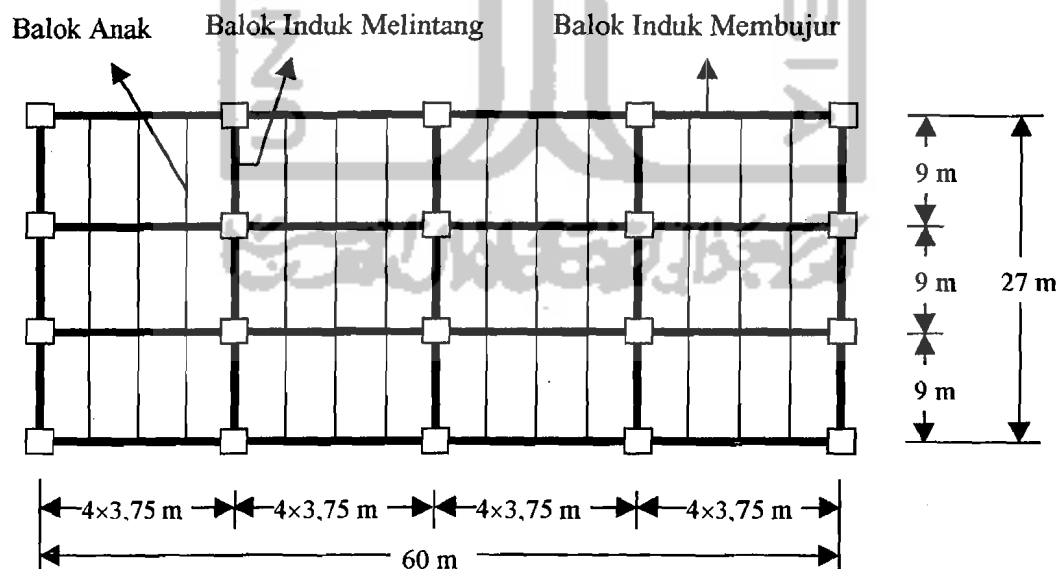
Denah Penempatan Balok Anak Tipe A
